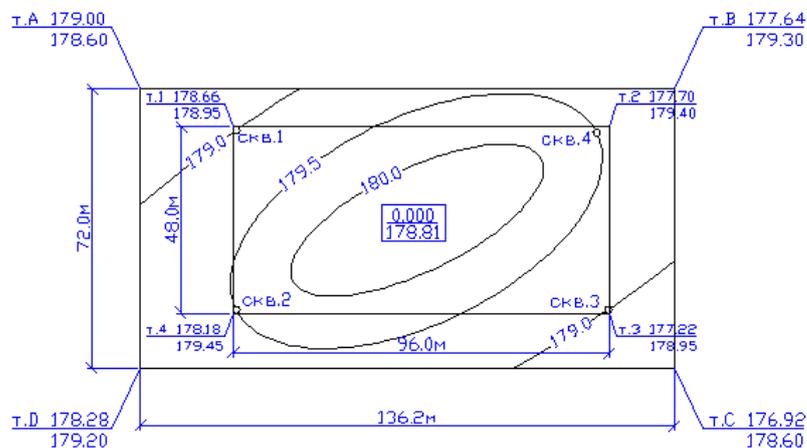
Схема плану будівельного майданчика і геологічних виробок
